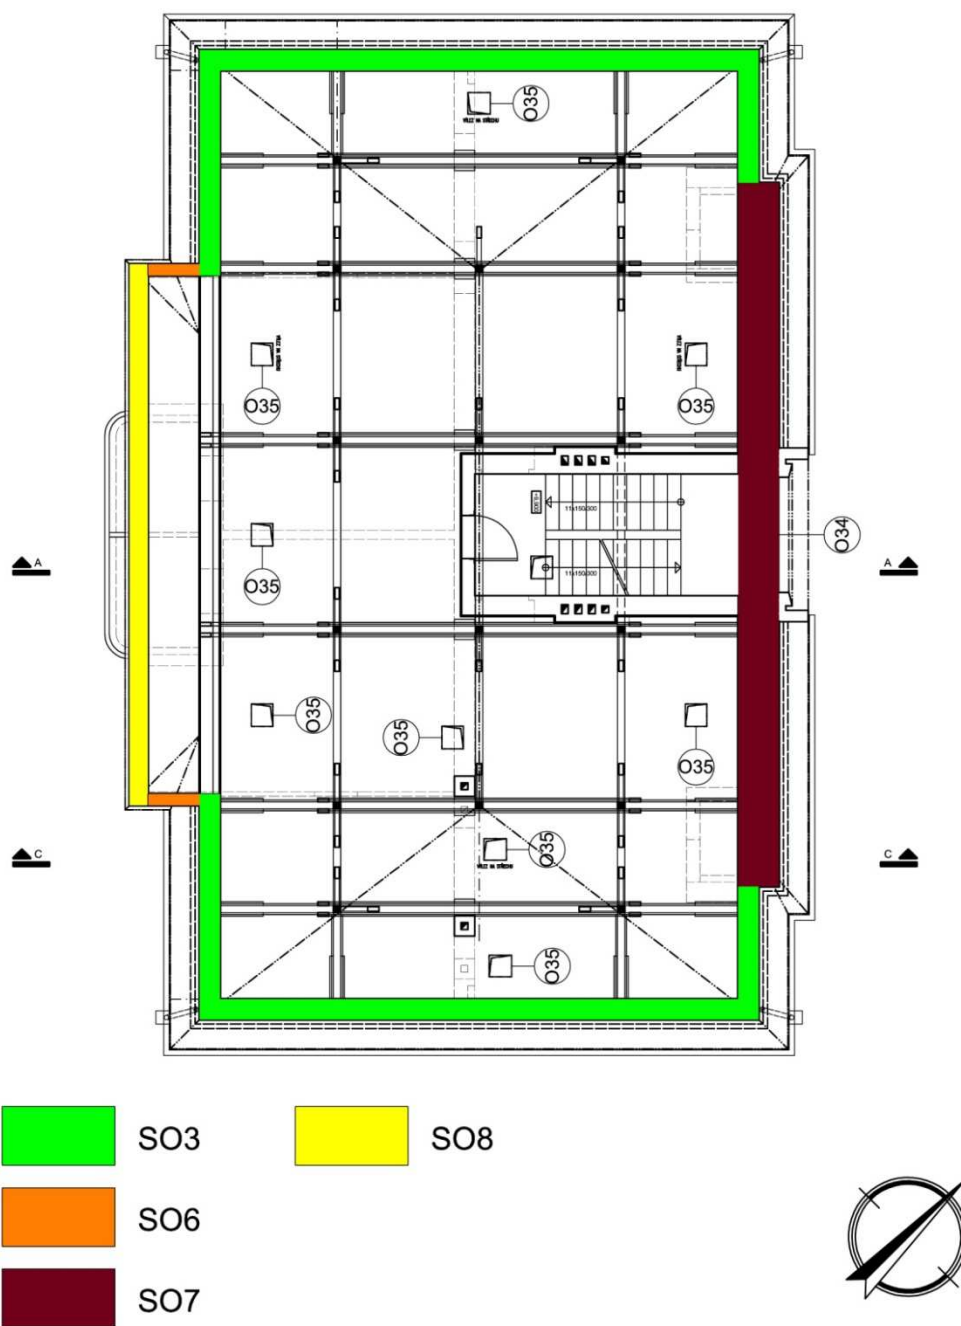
Svislé konstrukce 2. nadzemního podlaží
